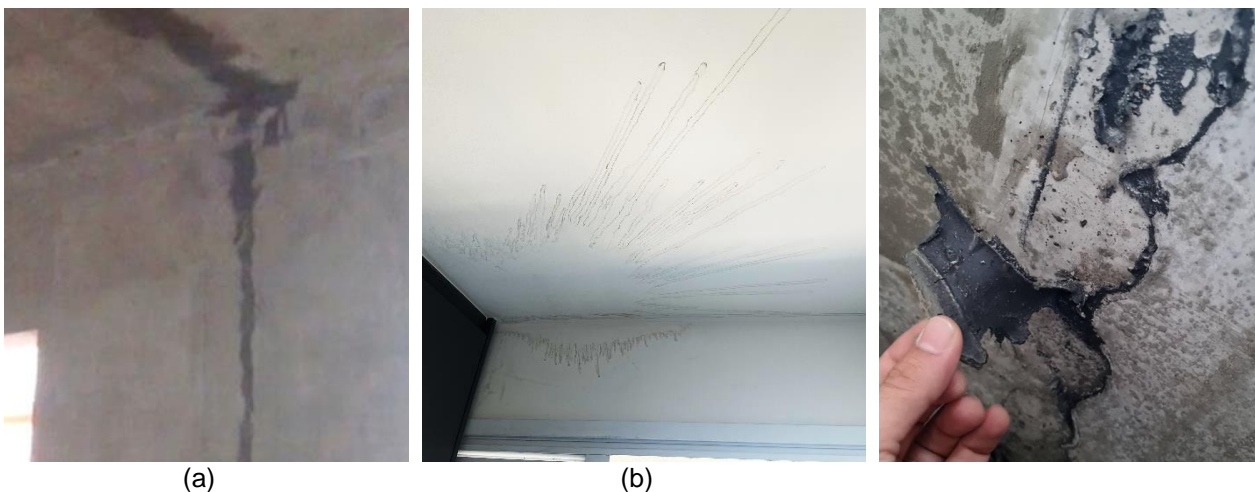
Infiltração de água pela junta de construção devido à falta de tratamento adequado (a) em junta vertical (parede/parede) e (b) em apartamento entregue no contato da parede com a laje e (c) exemplo de perfil hidroexpansivo deteriorado na junta de construção e com descolamento da estrutura (Arquivo Deseq, 2022)
